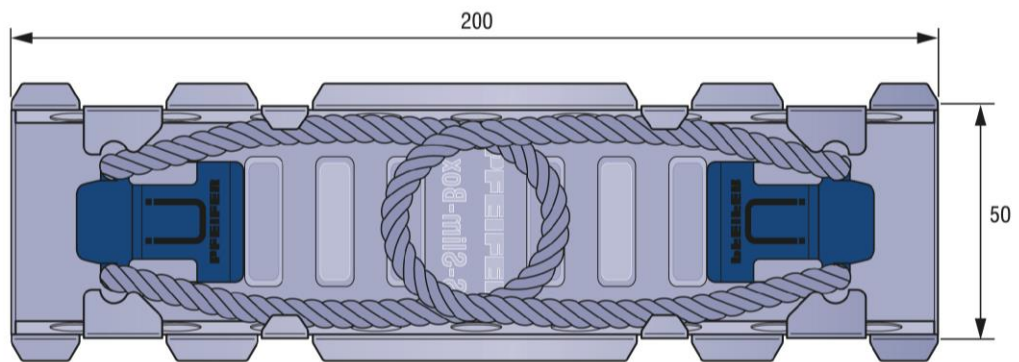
Draufsicht auf die geöffnete Box und die eingeklappten Seilschlaufen
